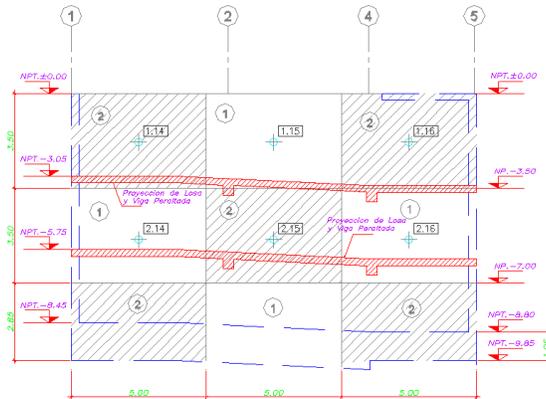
Muro Anclado - Detalle de Ubicación de Anclajes en “Eje A”.
